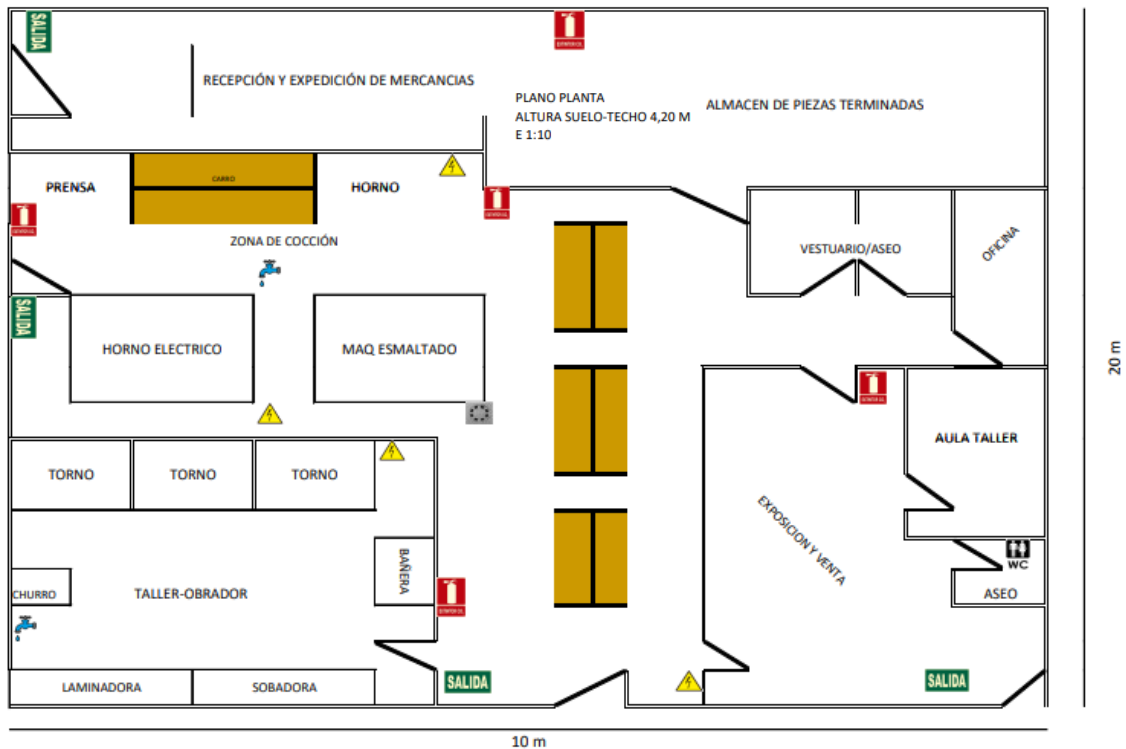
Plano del centro de trabajo: Elaboración propia.
